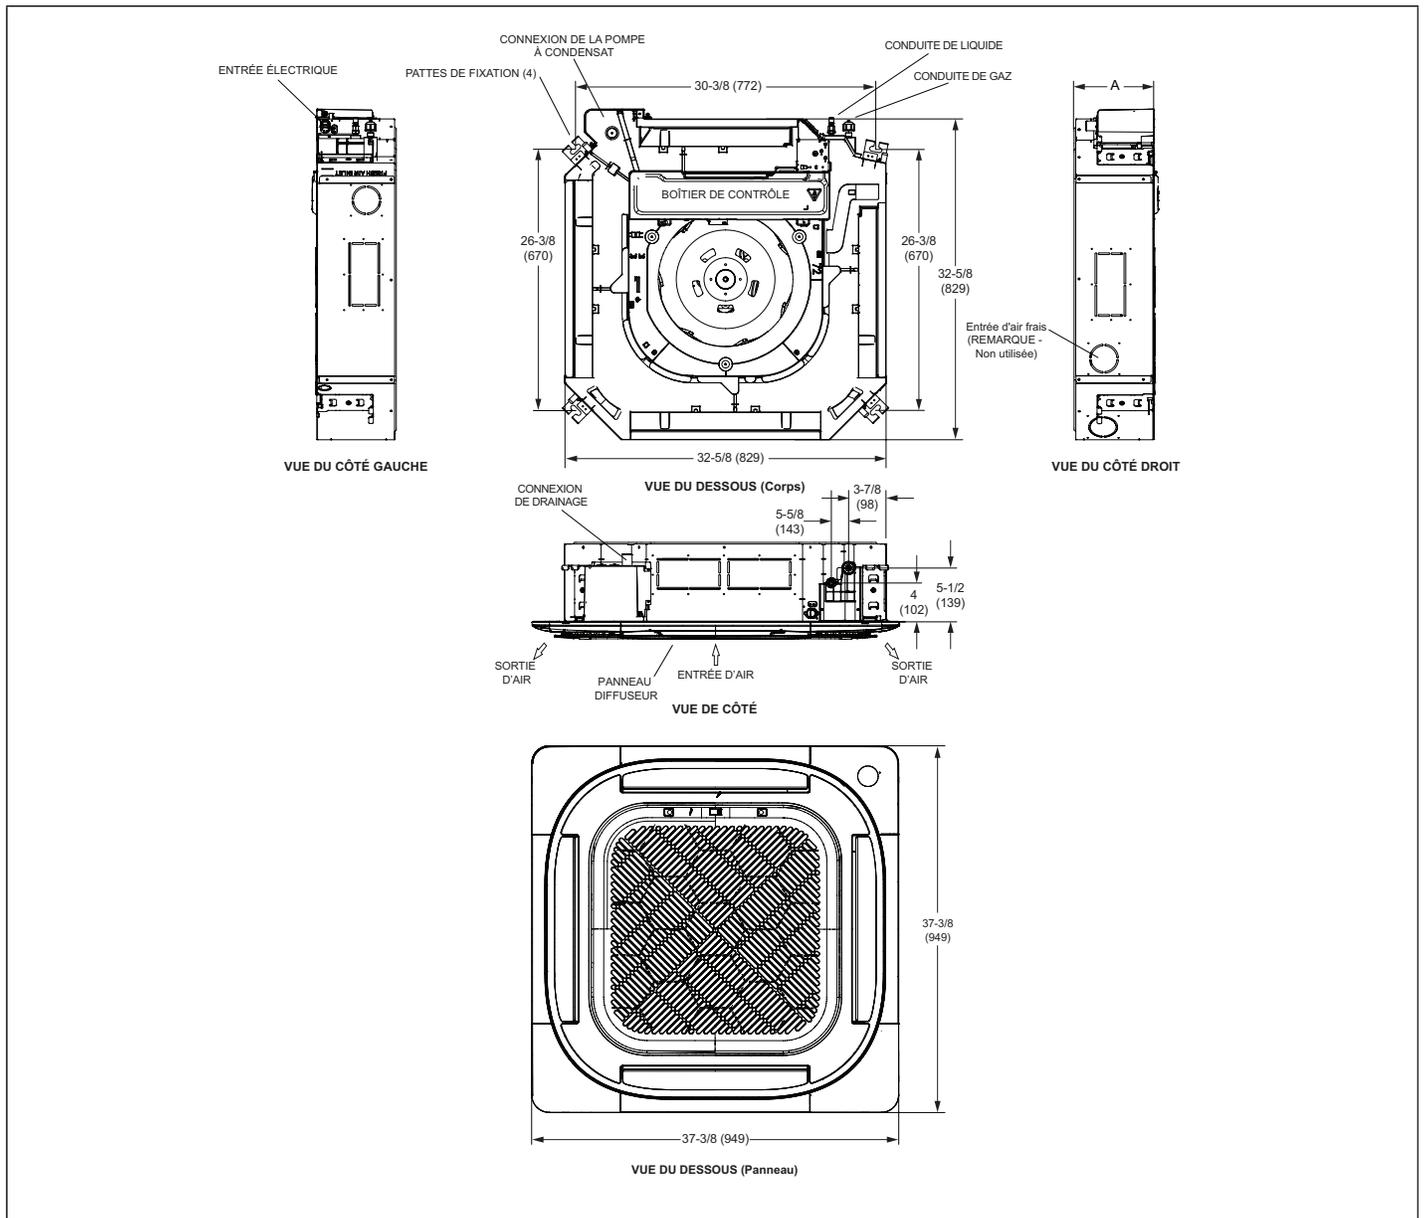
Dimensions des unités intérieures à cassette M33C - pouces (mm)
